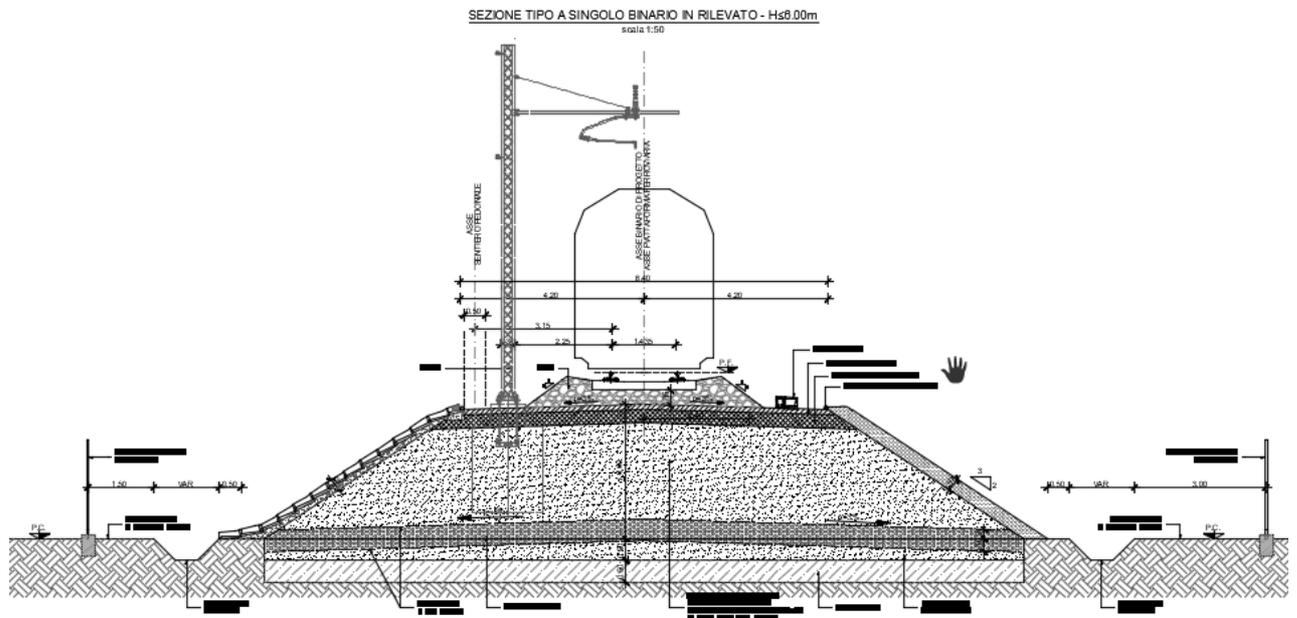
Sezione tipo SB in rilevato - asta L=750m
